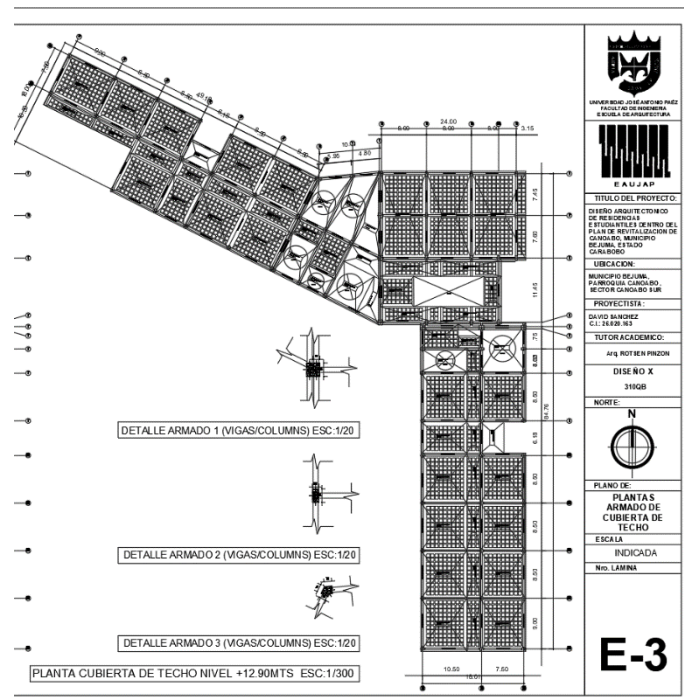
Detalles de cubierta de techo de la propuesta estructural
